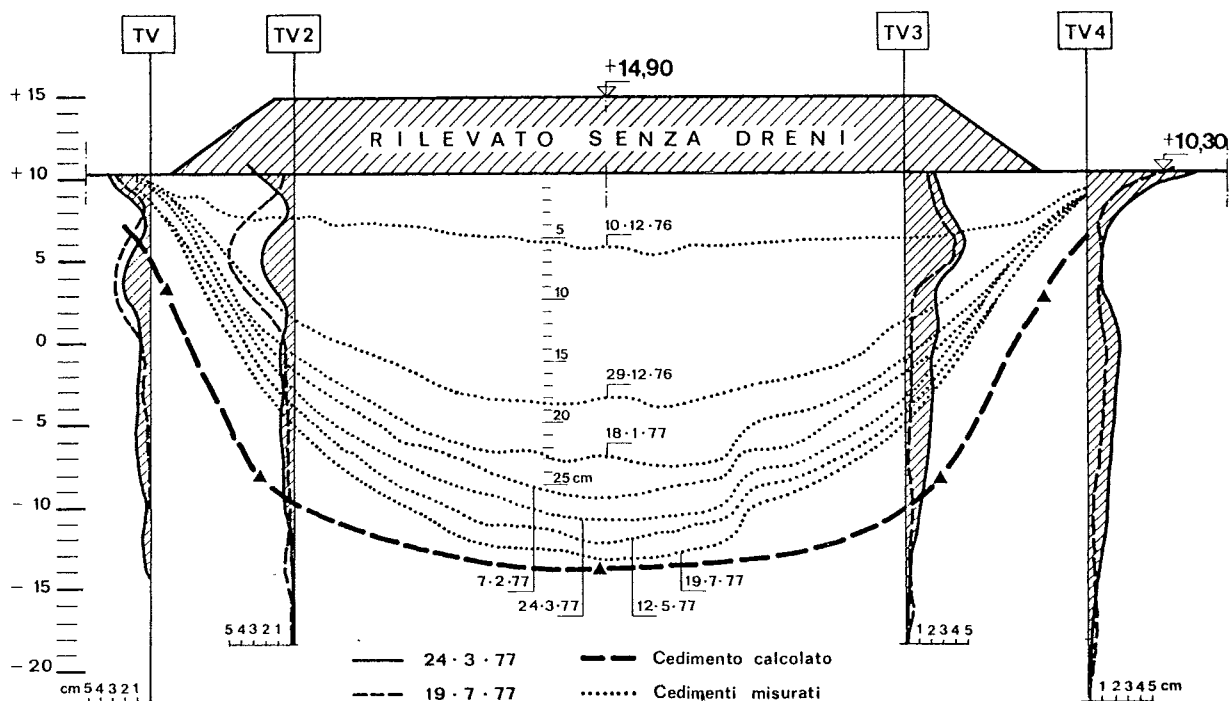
Rilevato sperimentale di Sermide - Confronto tra cedimenti calcolati e misurati.
